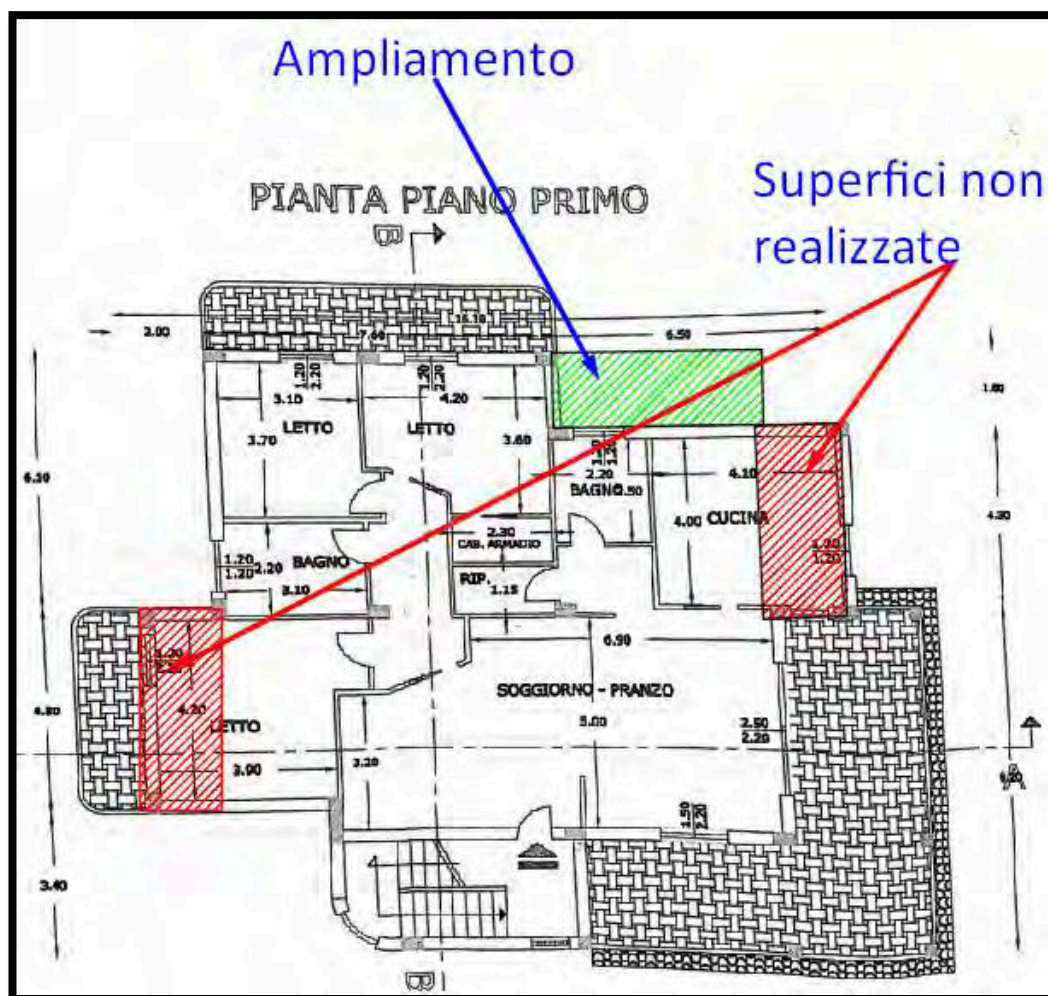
Stralcio elaborati di progetto allegati al Permesso a Costruire
